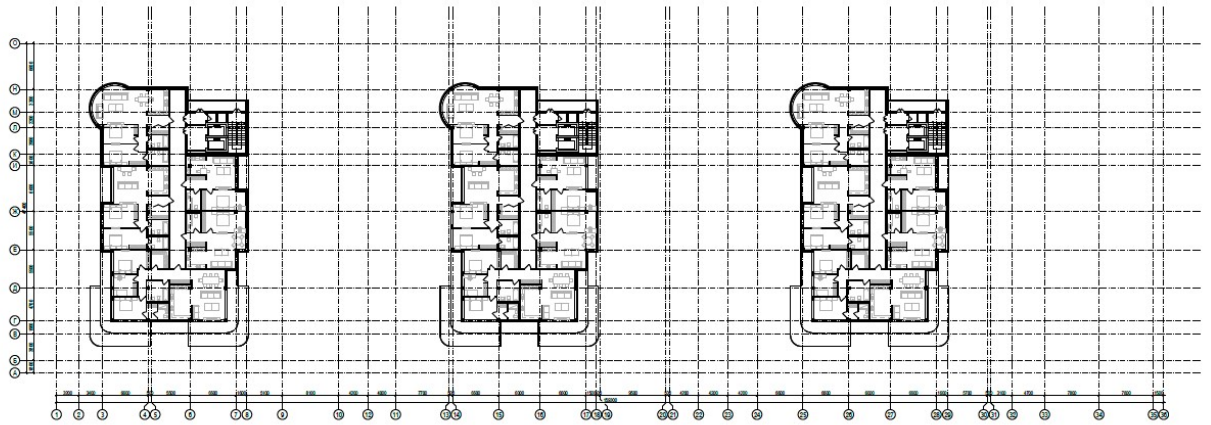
План четвертого поверху М1:200 на відмітці +10,200
